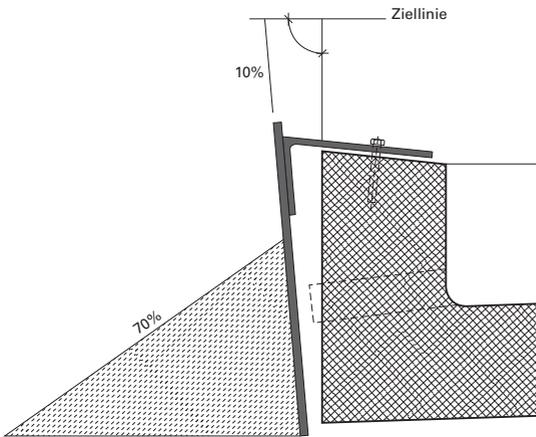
Scheibenstand mit vorschriftsgemäss befestigter Prellplatte (Montage an der Dachstirne beim Rolldach)
